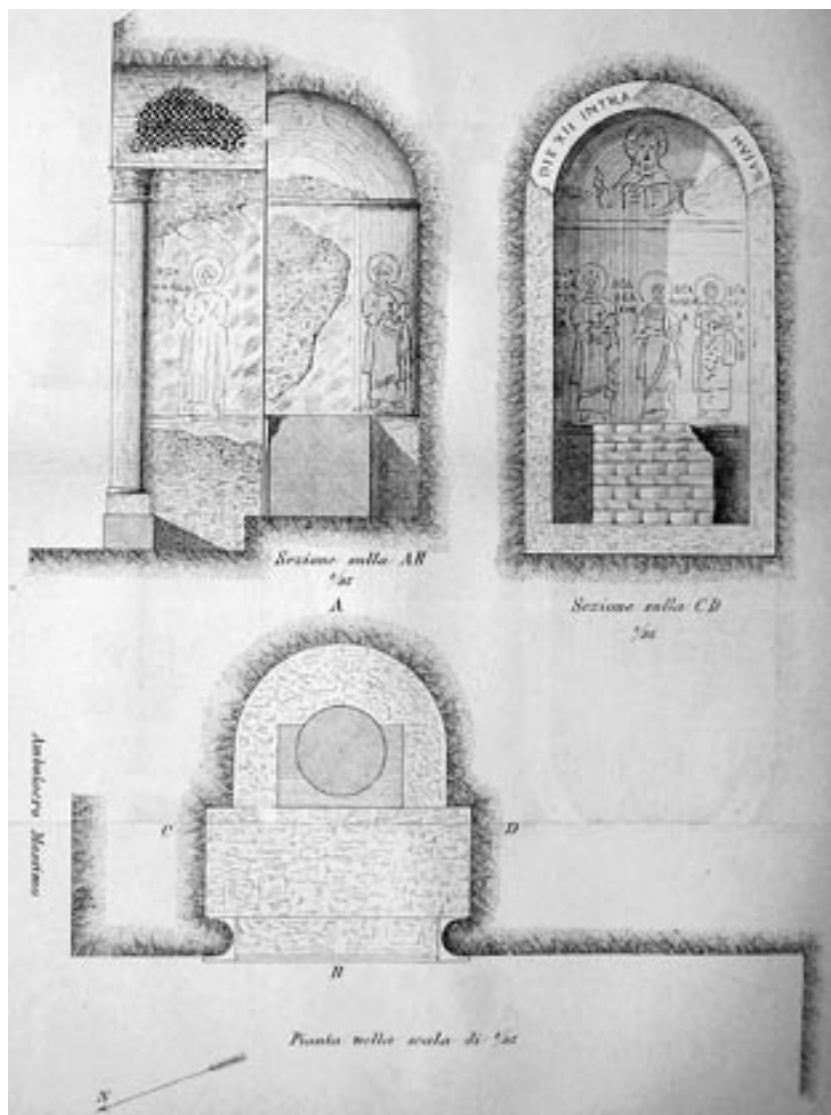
Catacomba di S. Gennaro, ‘vestibolo inferiore’. Sezione, prospetto e pianta della nicchia absidata nella parete di fondo (STORNAJOLO 1879, tav. II).
